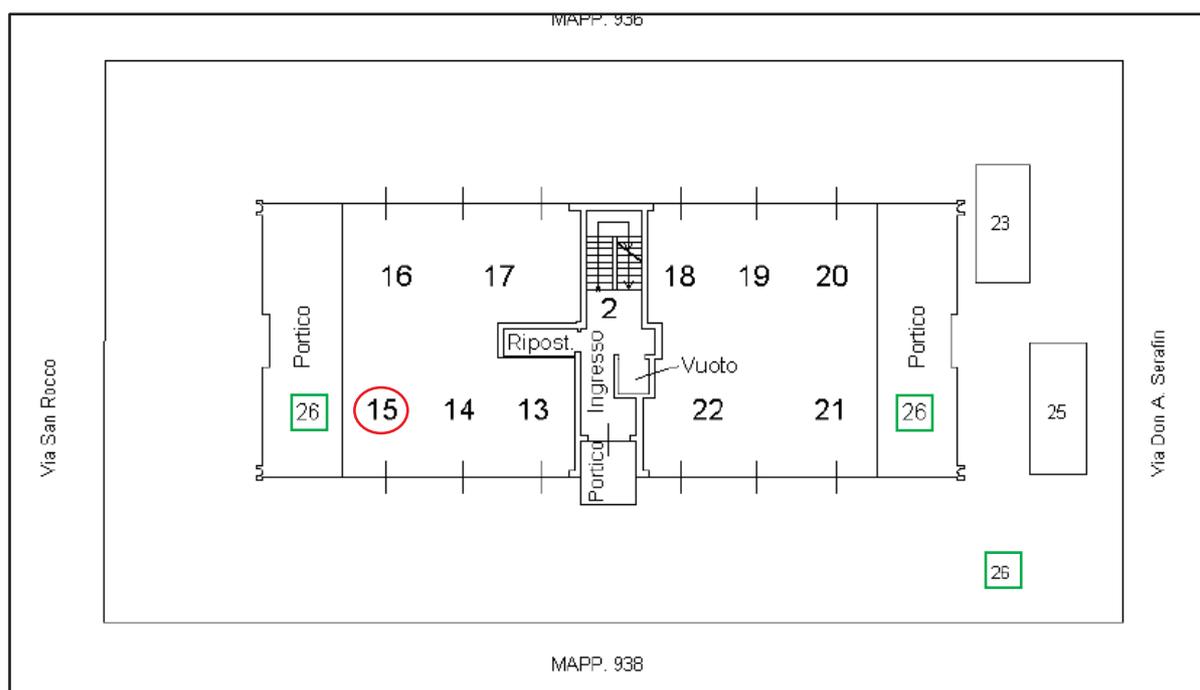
Pianta piano terra tratta dall'elaborato planimetrico
